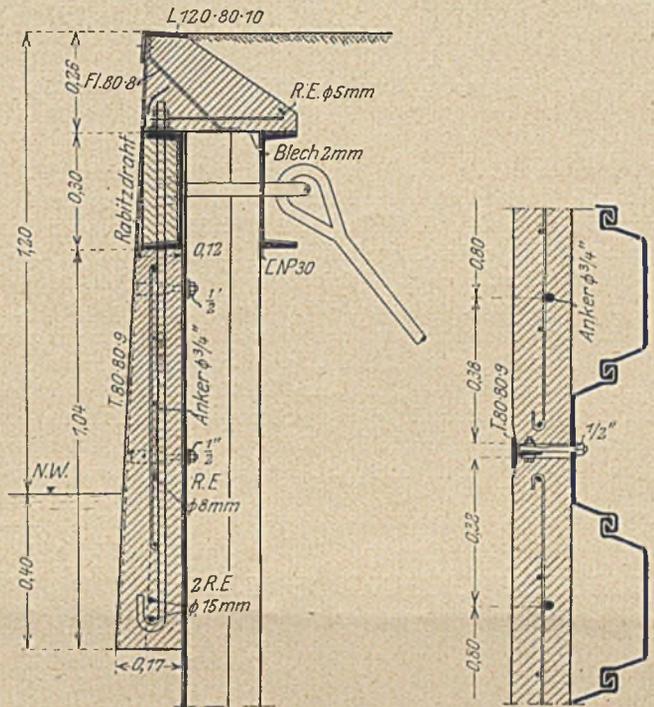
Querschnitt und Längsschnitt des umgebauten Deckwerks über dem Tunnel.
